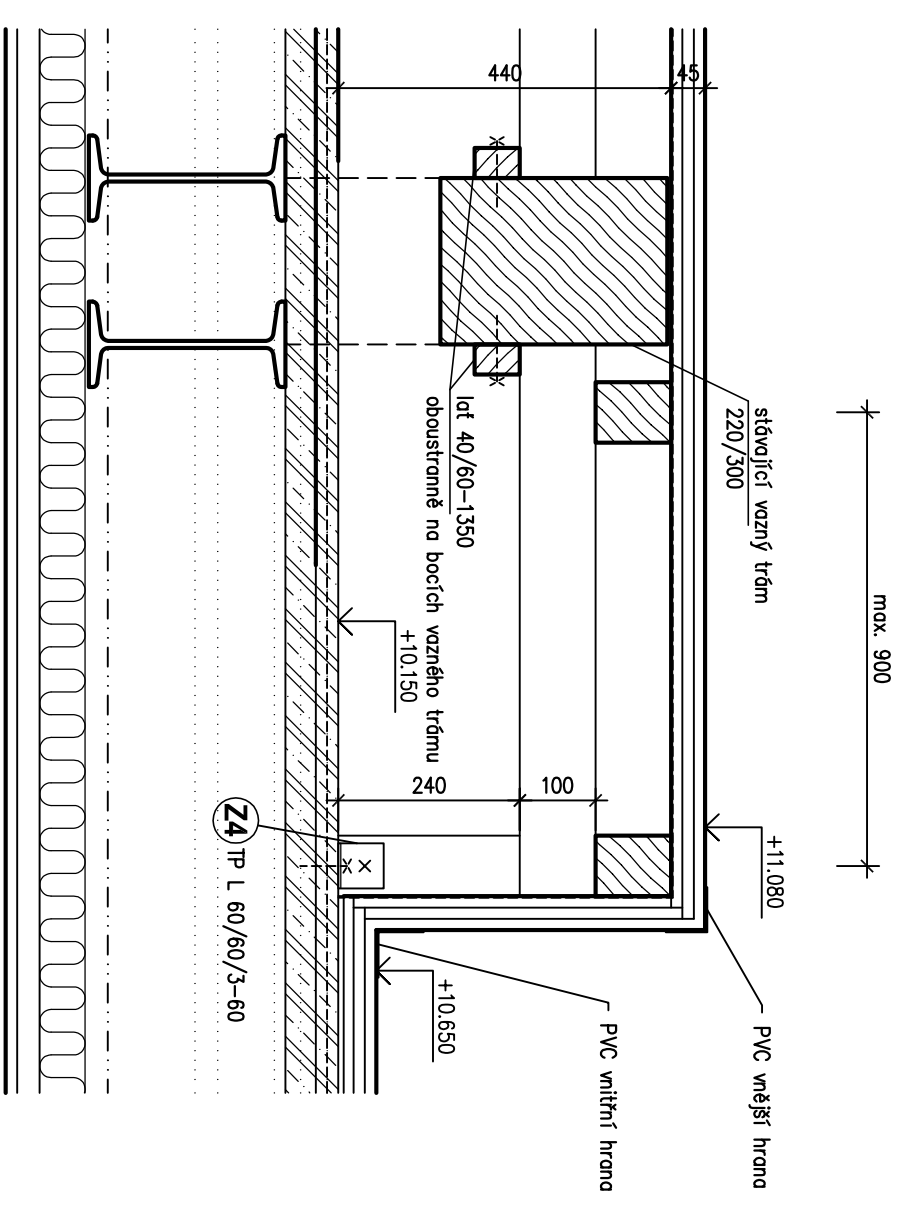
DETAIL ZRUŠENÉHO VÝLEZU NA STŘECHU 1:10
